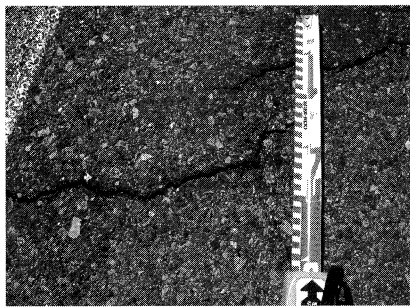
岩黒島橋中央分離帯付近のひび割れ
